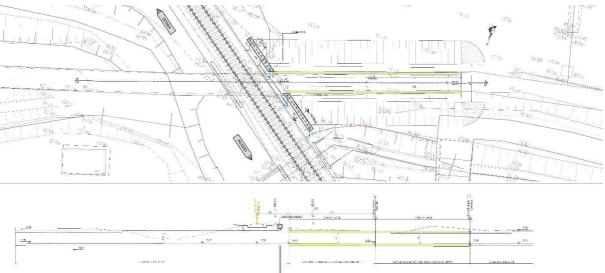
Attraversamento pk 19+757,50 – Stralcio Planimetrico e Sezione Longitudinale Fase 1 In fase 2, dopo lo spostamento dell'esercizio ferroviario sullo scatolare realizzato in fase 1, si prevede:
